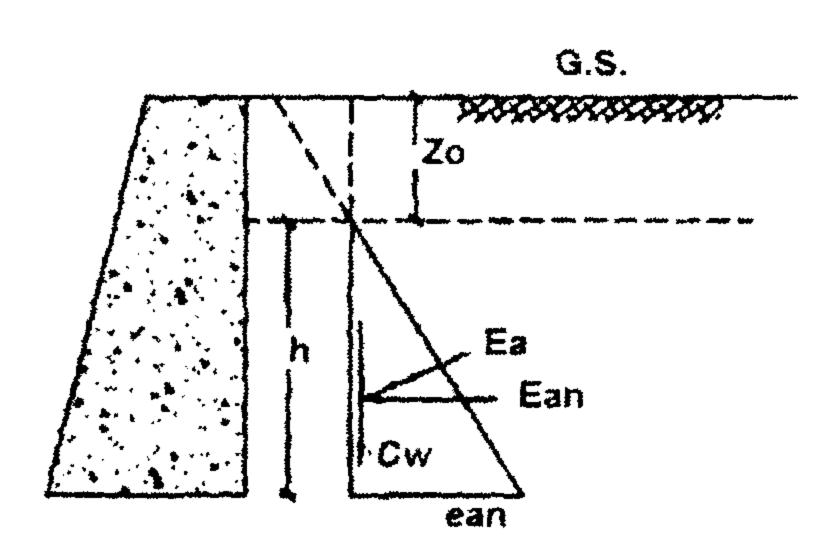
حائط ساند لتربة ذات سطح مستوى أفقي
